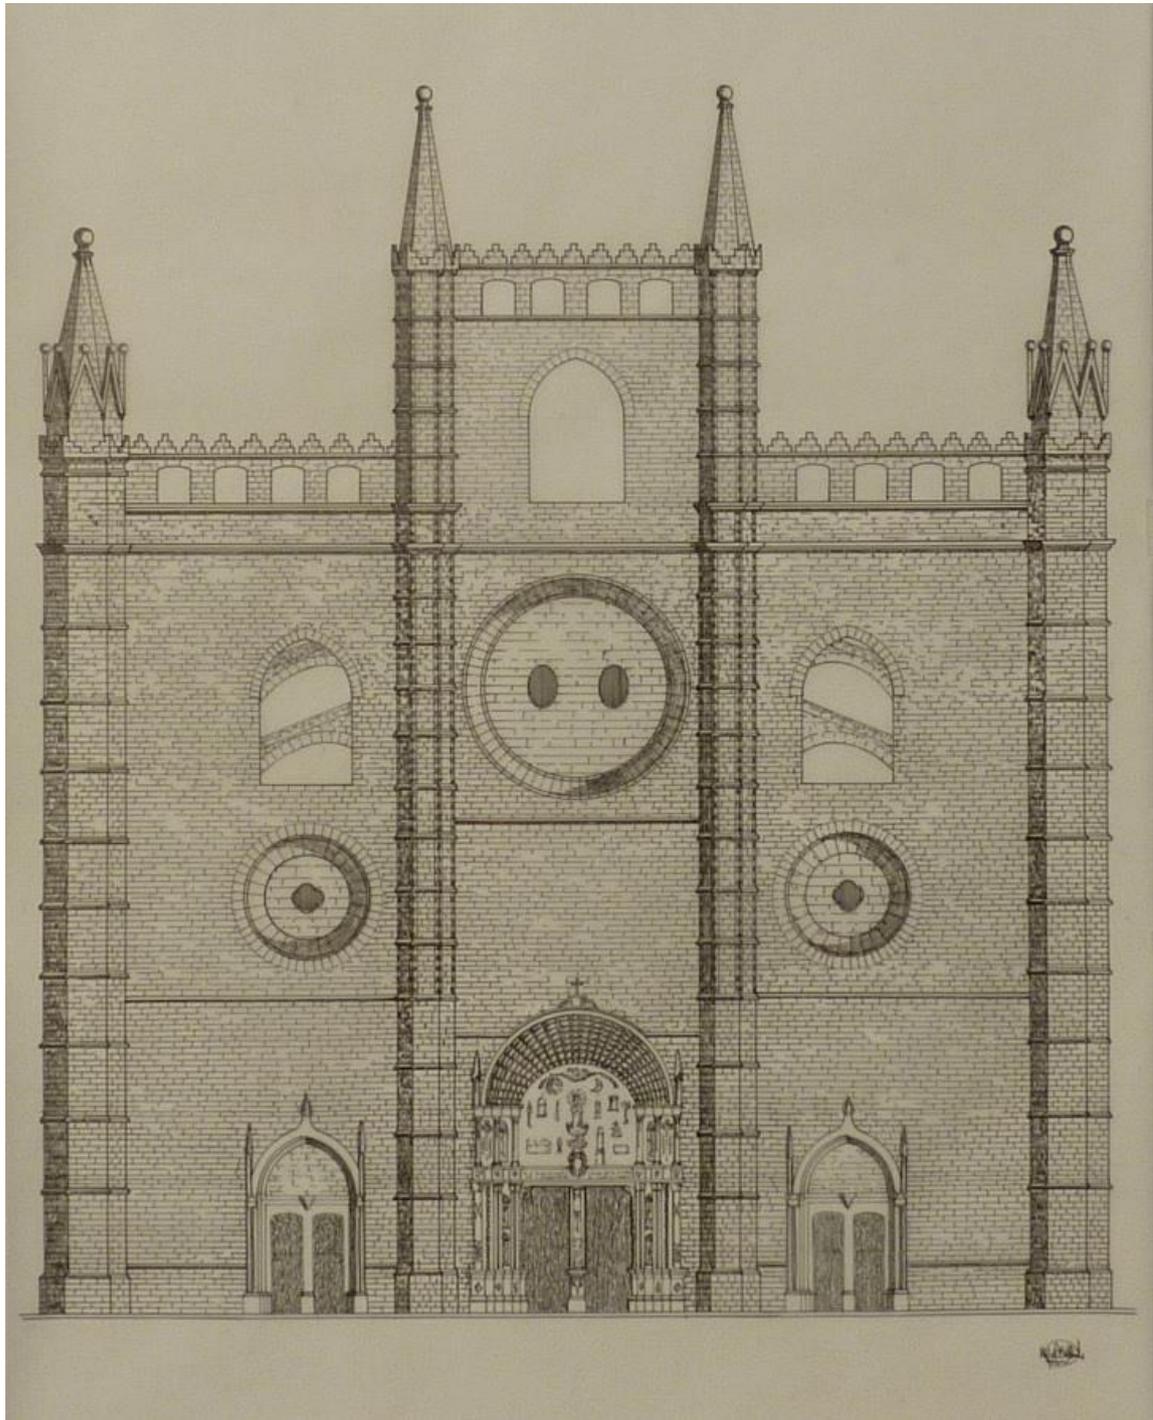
Recreación de la fachada de la Almudaina. Autor: M. Ballester.
